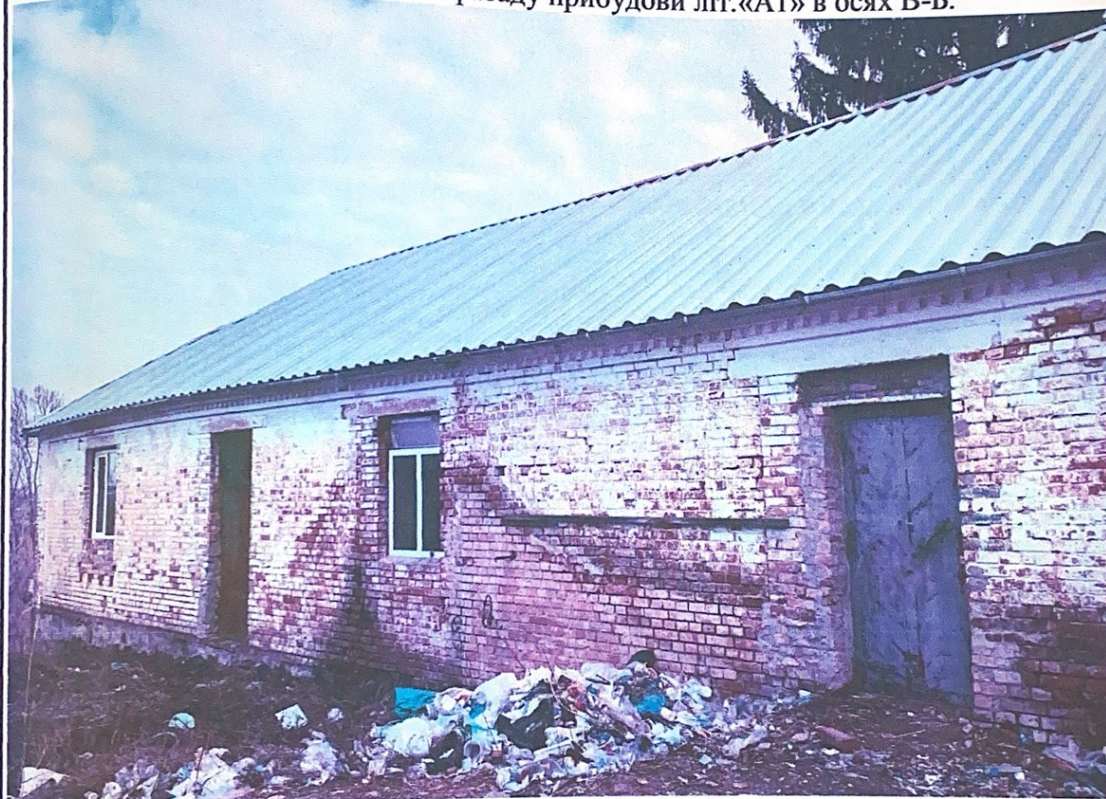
Фрагмент фасаду прибудови літ.«А1» в осях Е-Б.
